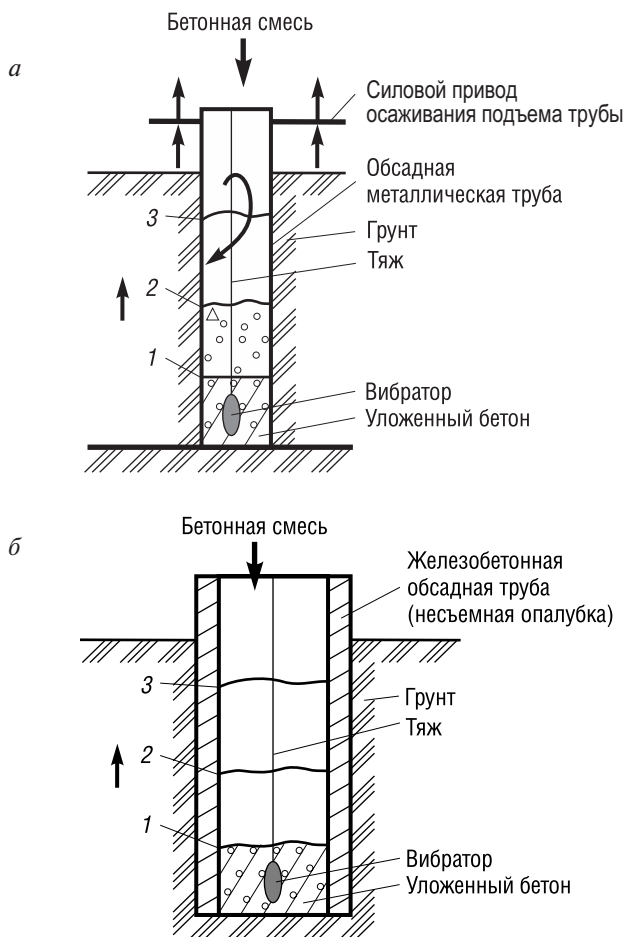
Принципиальные схемы бетонирования с обсадными трубами:
